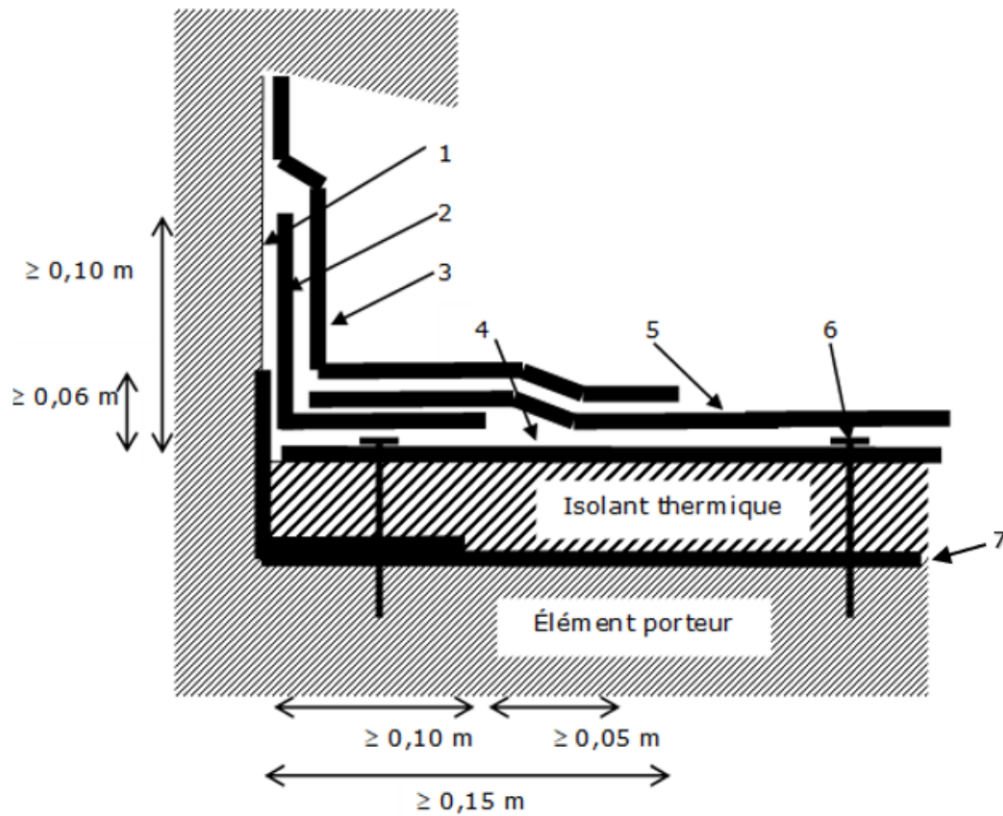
Coupe sur rangée de fixations complémentaires et bande de recouvrement
